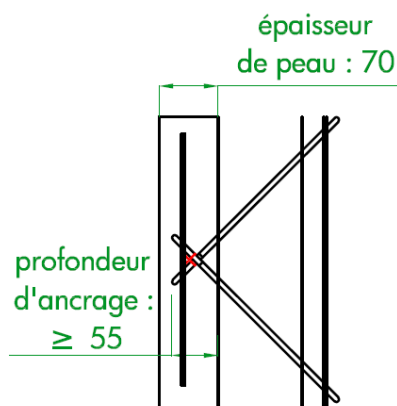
Profondeur d'ancrage pour les étriers SPA-1 et SPA-2
